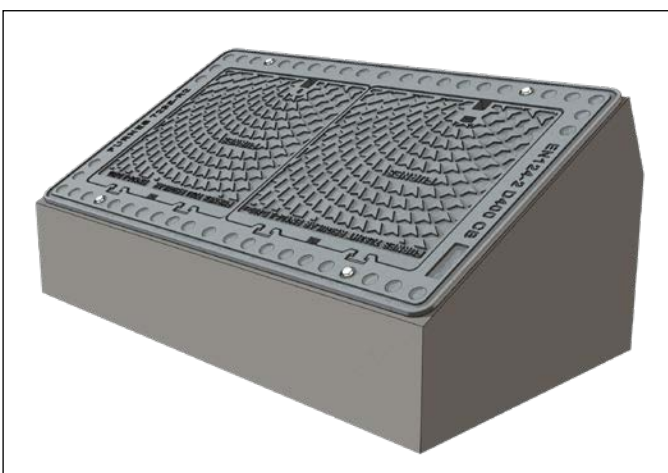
7295-2/7293HT, montert i skrå kum.
